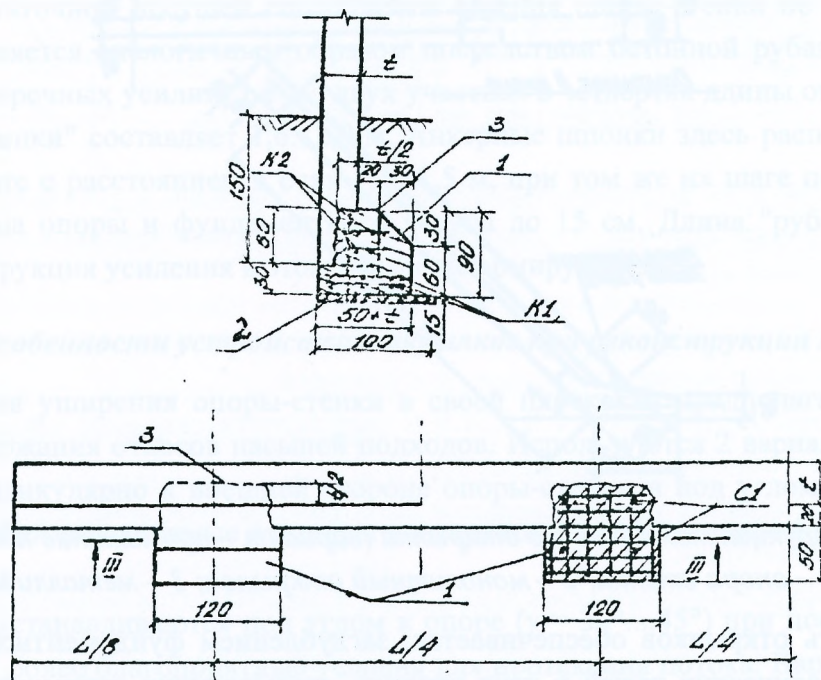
Усиление фундамента опор-стенок железобетонными шпорами: 1 – железобетонная шпонка; 2 – щебеночное основание; 3 – выкол бетона фундаментной части опоры.
